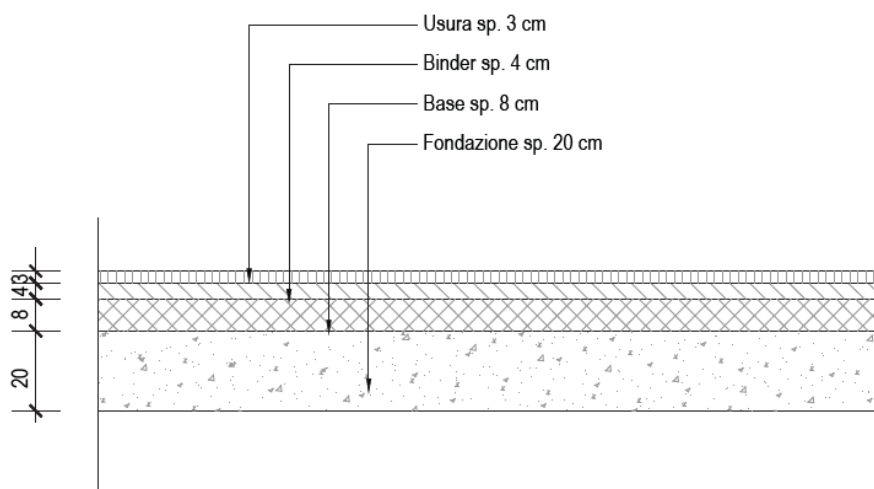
Pacchetto di pavimentazione NV04.1 e Viabilità parcheggio
